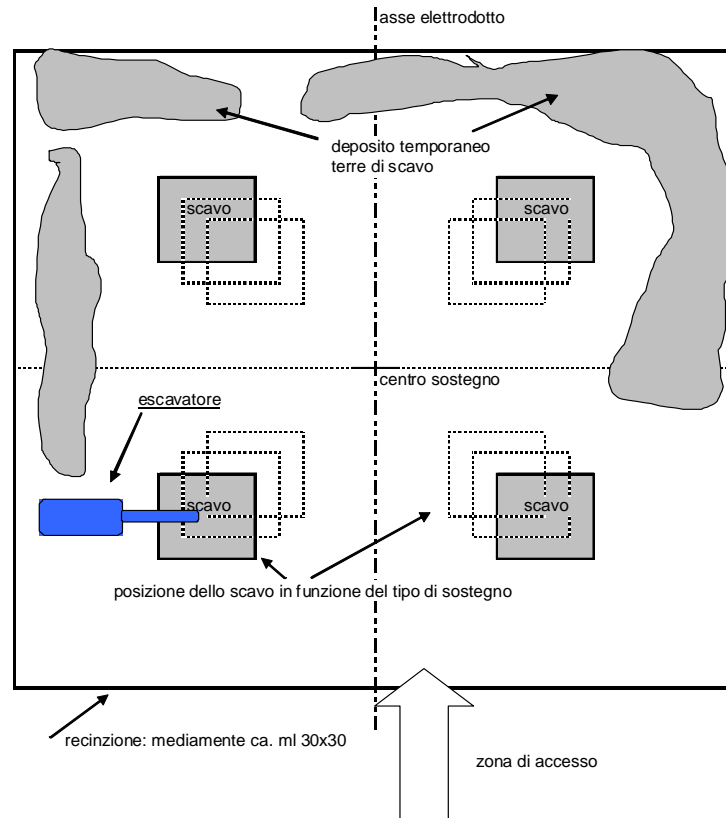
Planimetria dell'Area Sostegno tipo (scavo di fondazione)
